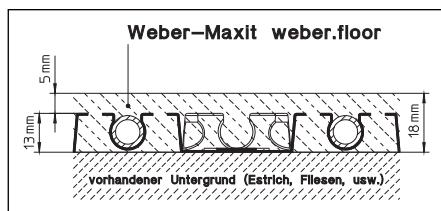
Weber-Maxit weber.floor (Mindestüberdeckung 5 mm, Gesamtaufbauhöhe 18 mm)
